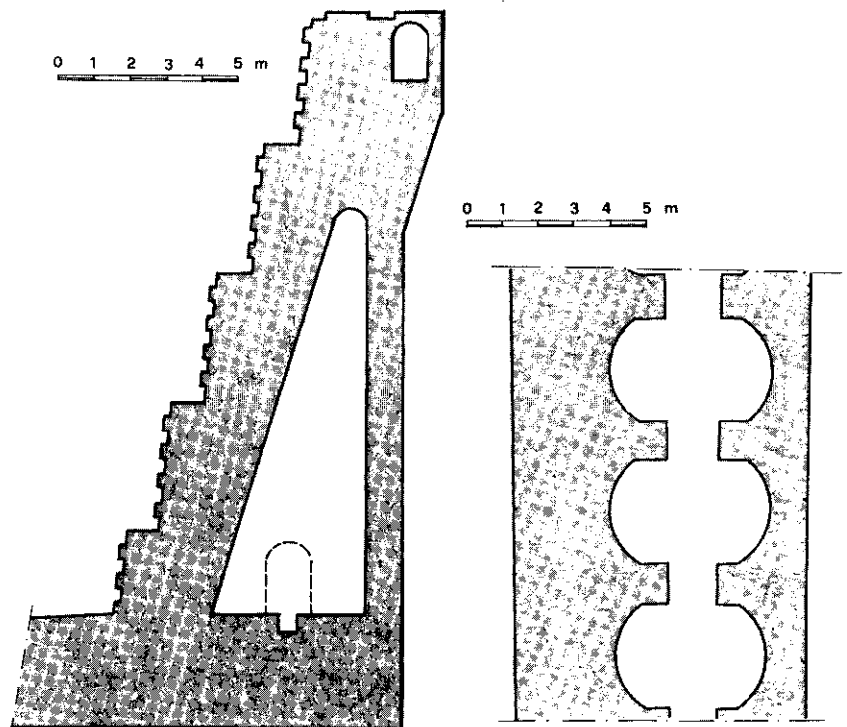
muro perimetrale della vasca di carenaggio. Sezione verticale tipo. Fig. 2: Sezione orizzontale alla base delle camere di alleggerimento.
